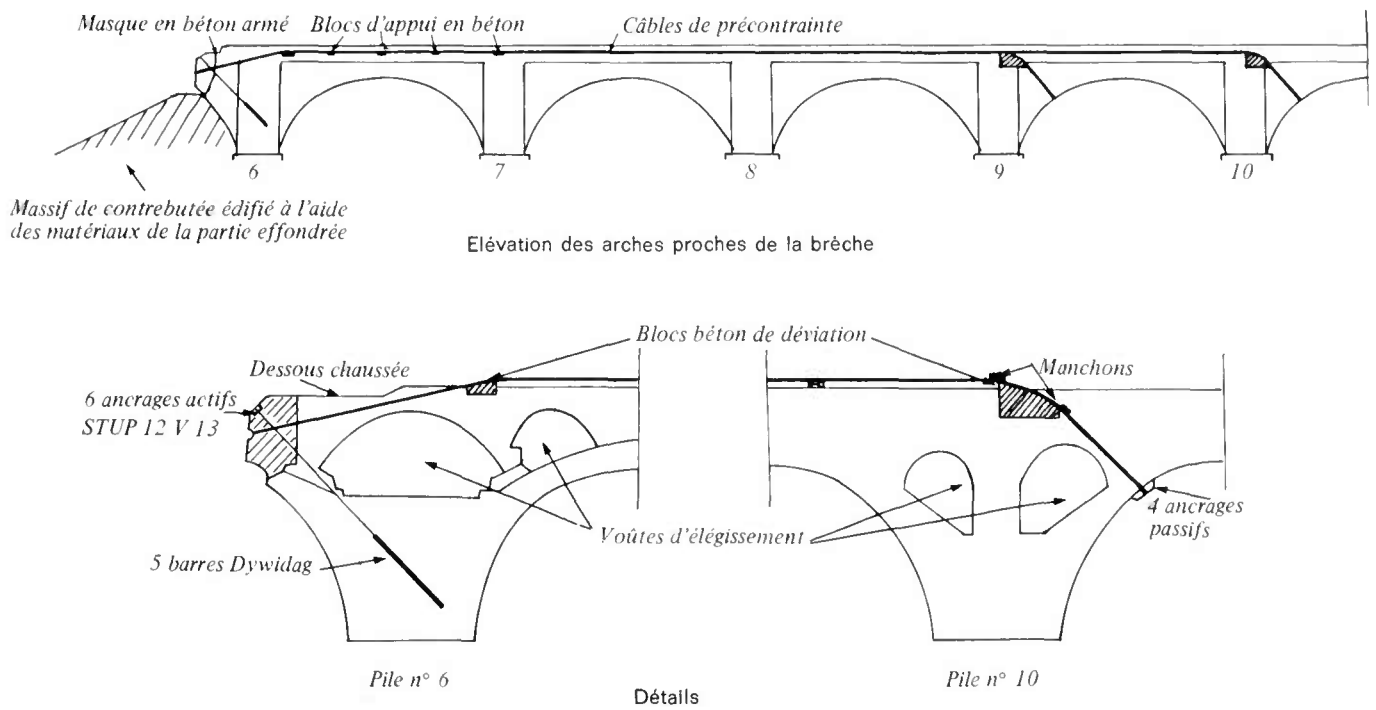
Pont Wilson. Mesures conservatoires.
